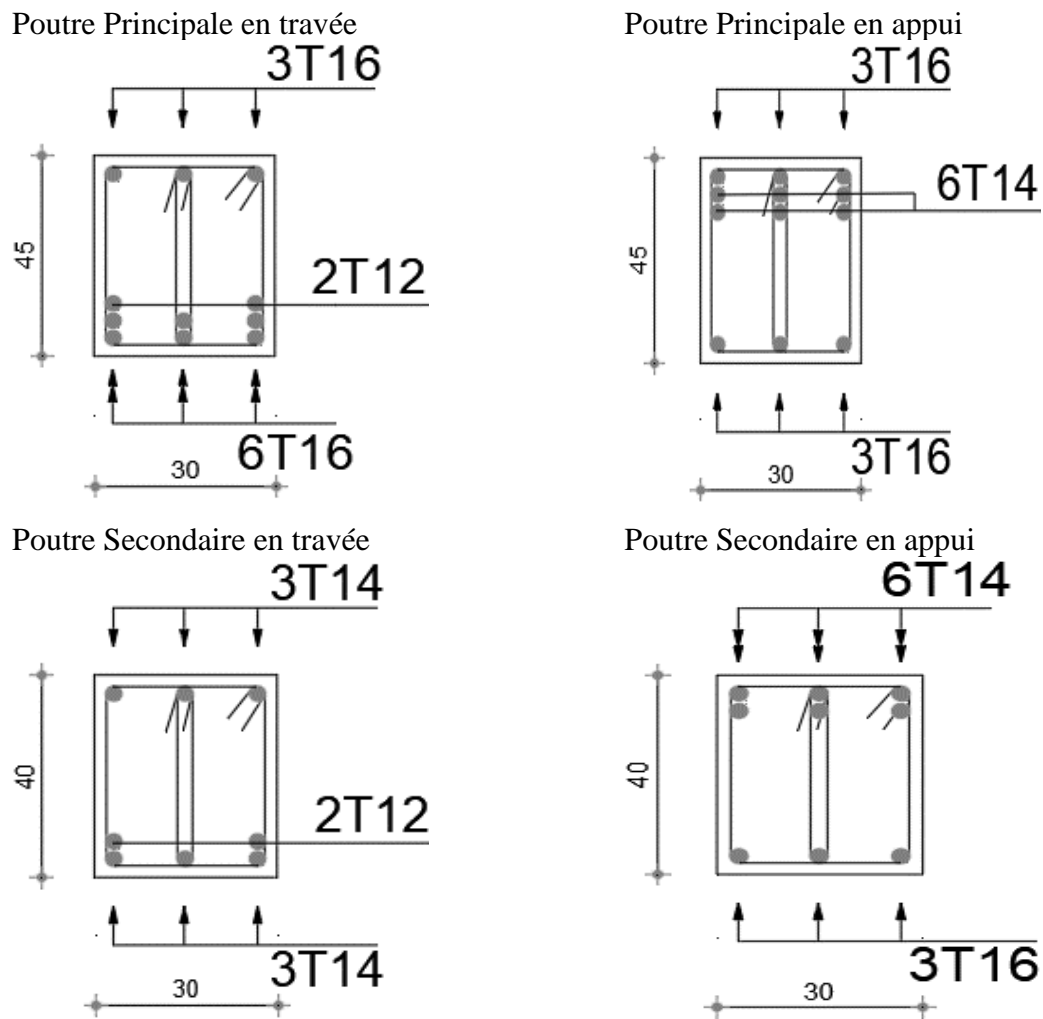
Ferrailages des poutres principale et les poutres secondaire.
